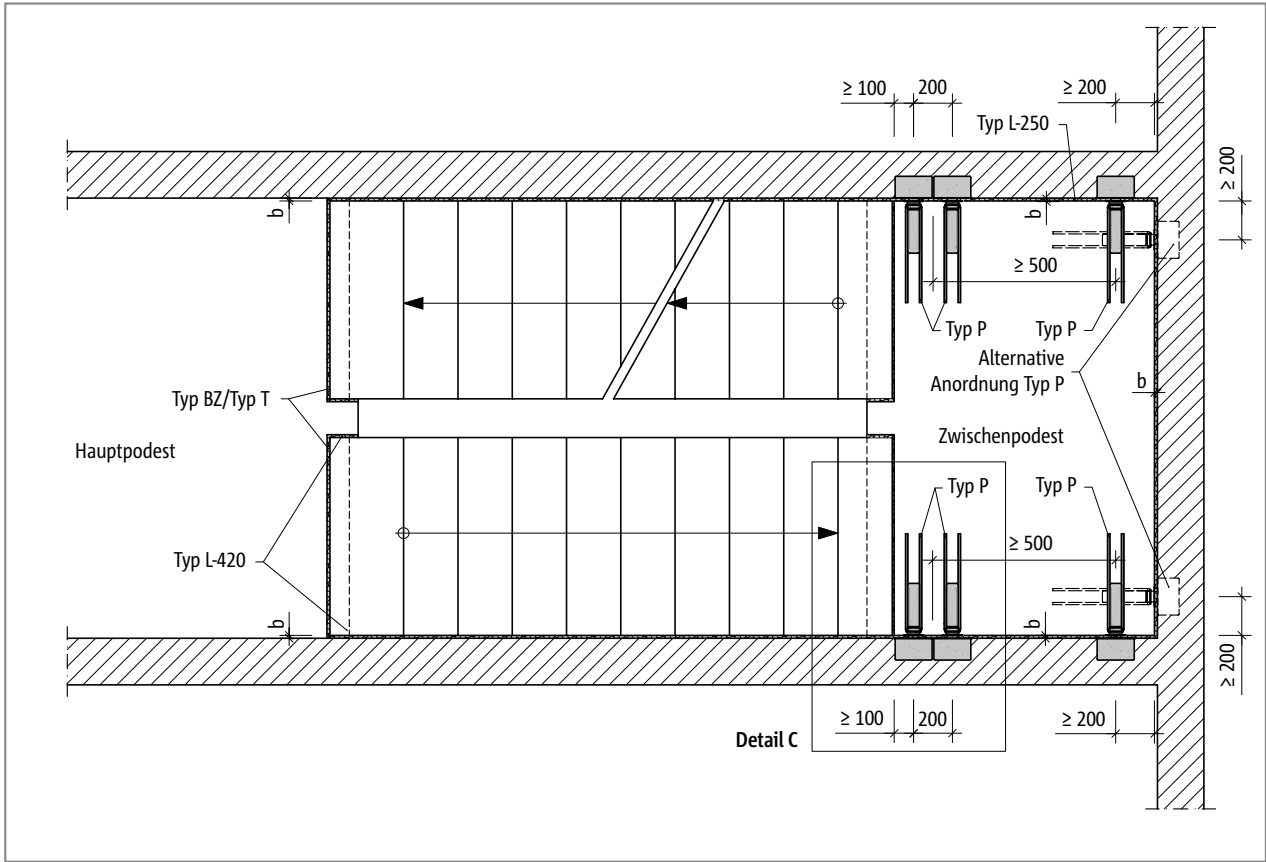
Schöck Tronsole® Typ P: Elementanordnung, Detail B
